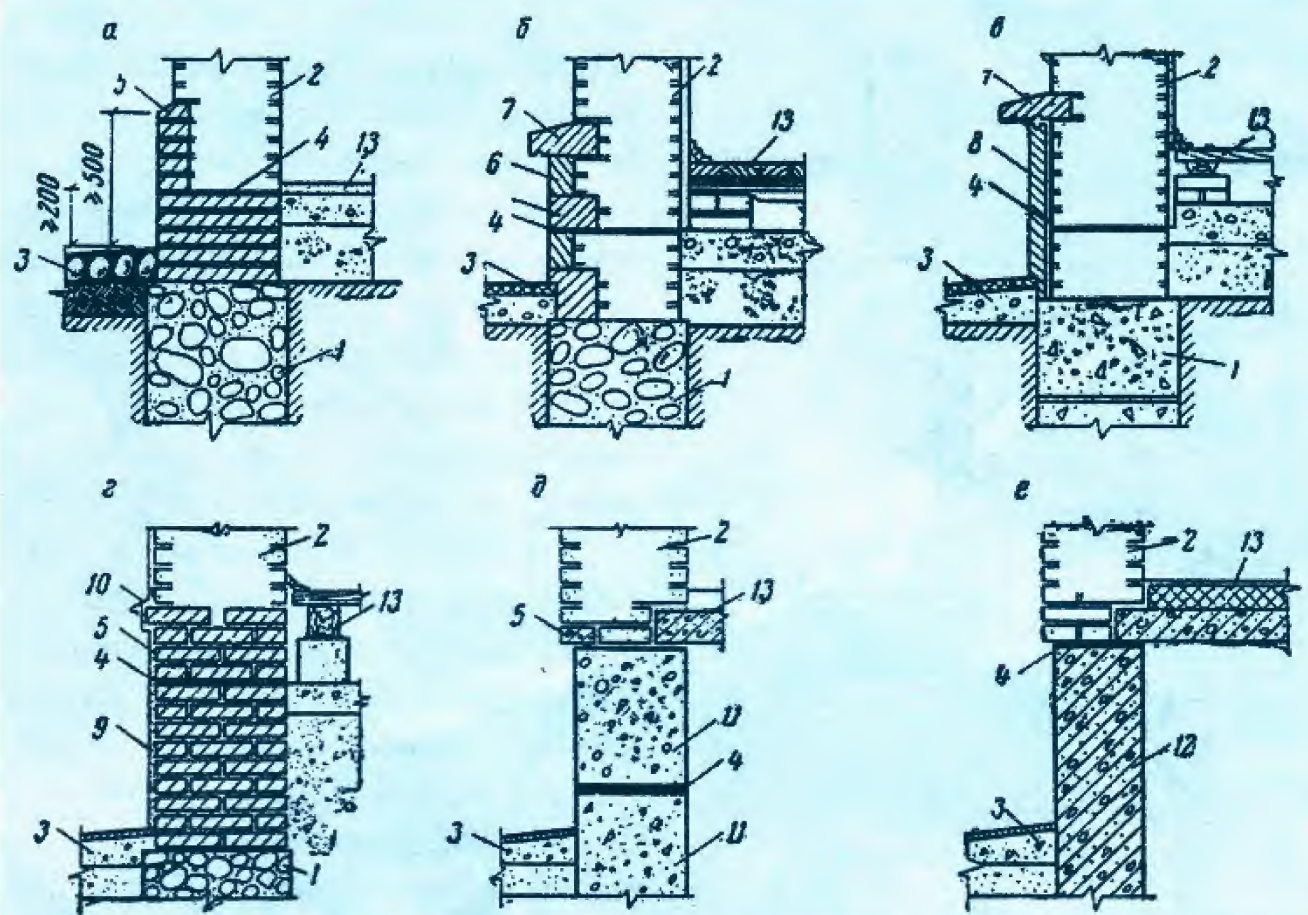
Типи конструкцій цоколів: а – обкладений цеглою; б – обкладений камінними блоками; в – обкладений плитами; г – оштукатурений; д – з бетонних блоків; е – з залізобетонних панелей; 1 – фундамент; 2 – стіна; 3 – відмощення; 4 – гідроізоляція; 5 – цегла; 6 – цокольні кам'яні блоки; 7 – бортові цокольні камені; 8 – облицювальні плити; 9 – штукатурка; 10 – покрівельна сталь; 11 – бетонний блок; 12 – панель фундаментної стіни; 13 – конструкція підлоги першого поверху.
